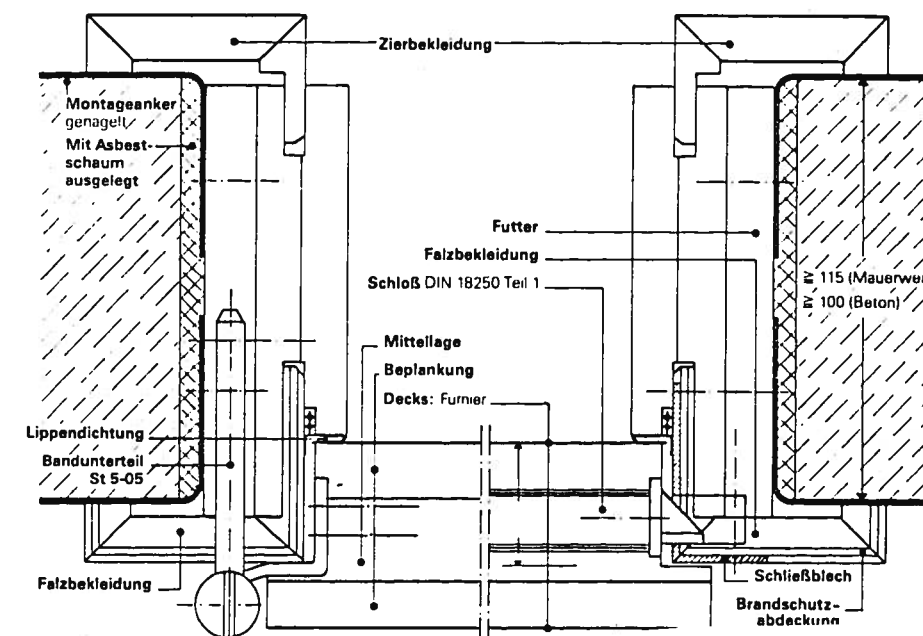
Waagrechter Schnitt durch eine Brandschutztür
